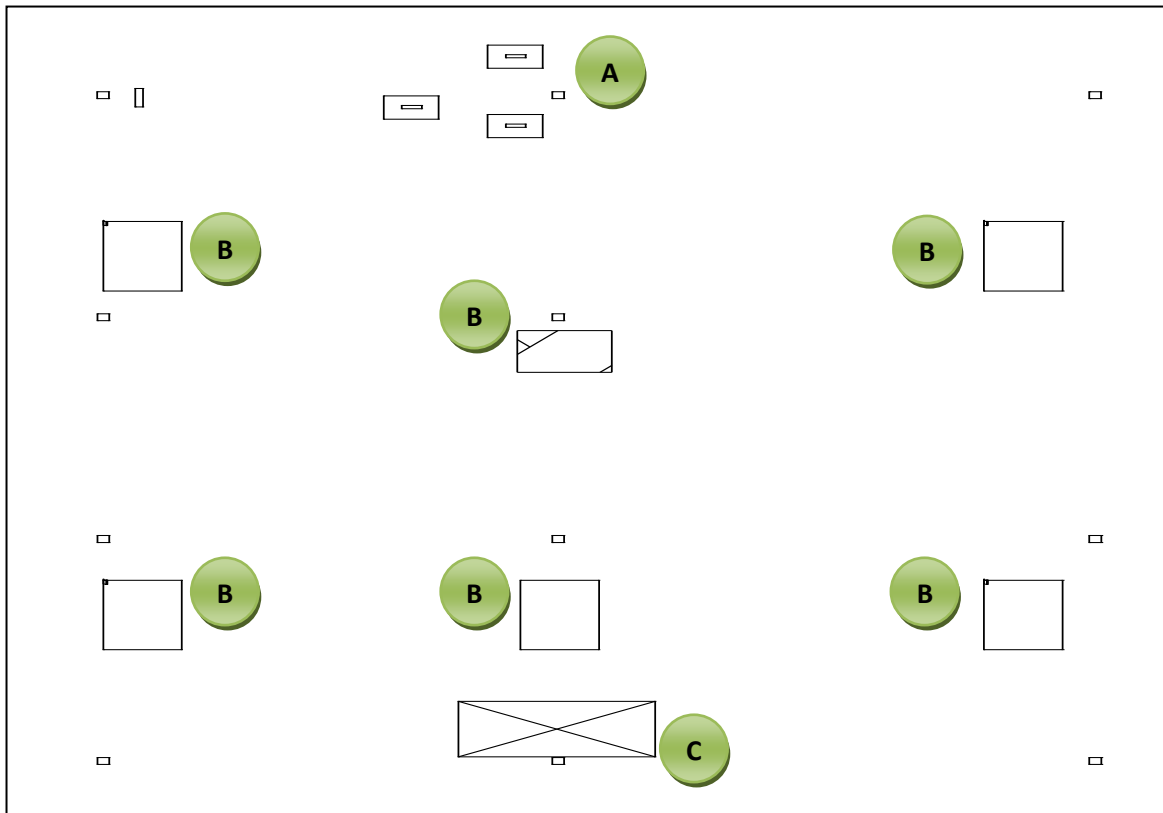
, Taller de Fabricación y soldadura
